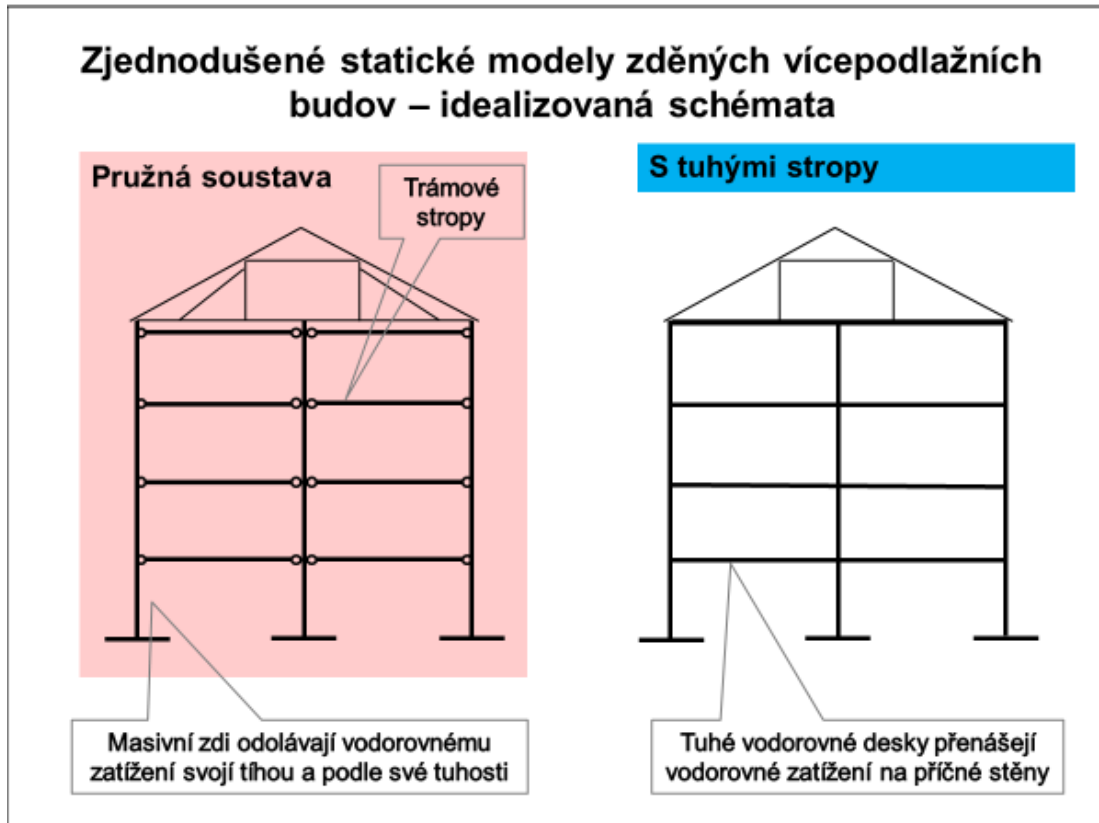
Případy uložení stropní konstrukce na zdivo
